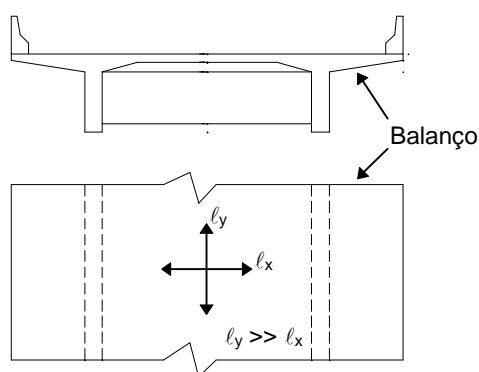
Forma típica da laje do tabuleiro de pontes com duas vigas retas e transversinas desligadas.
